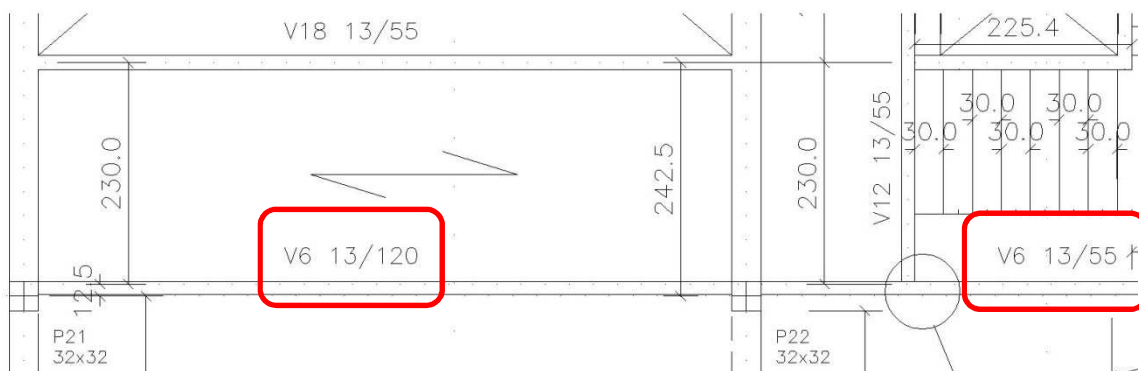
Planta de forma da estrutura do 1º pavimento em destaque a viga V6 em dois trechos distintos.
